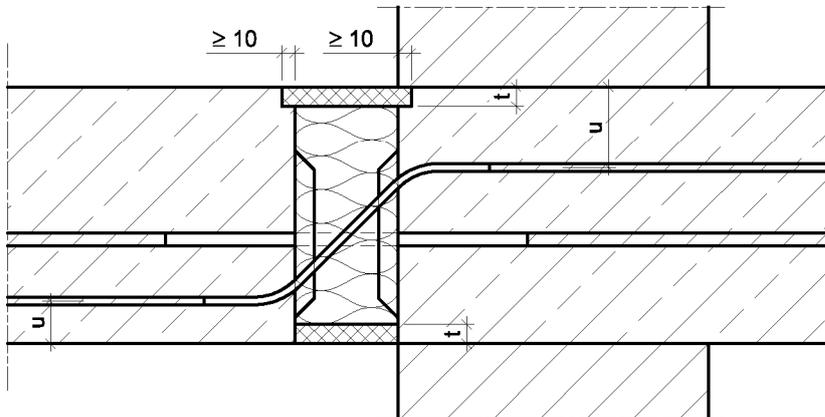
Schöck Isokorb Typ Q und Typ QF (F30/F90)
